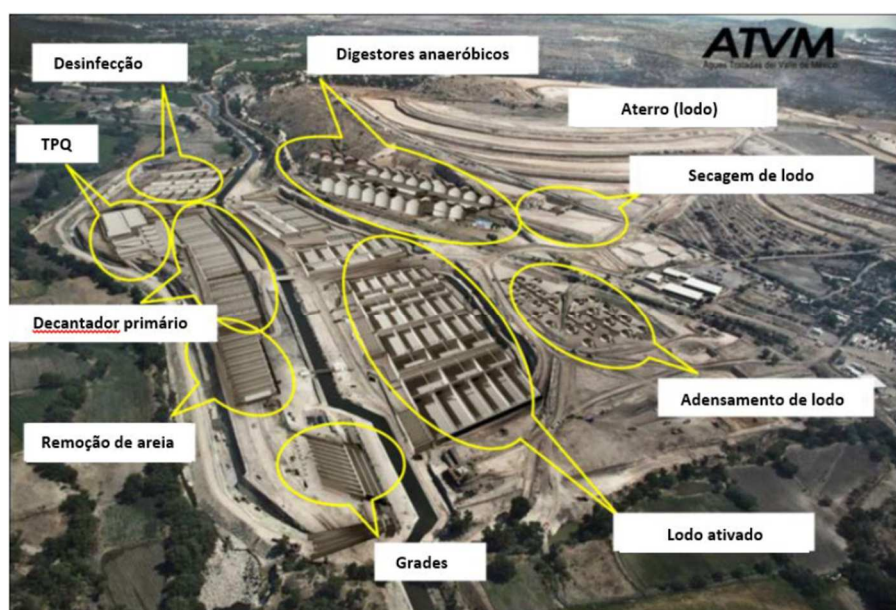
Layout das instalações da ETE Avançada Atotonilco
